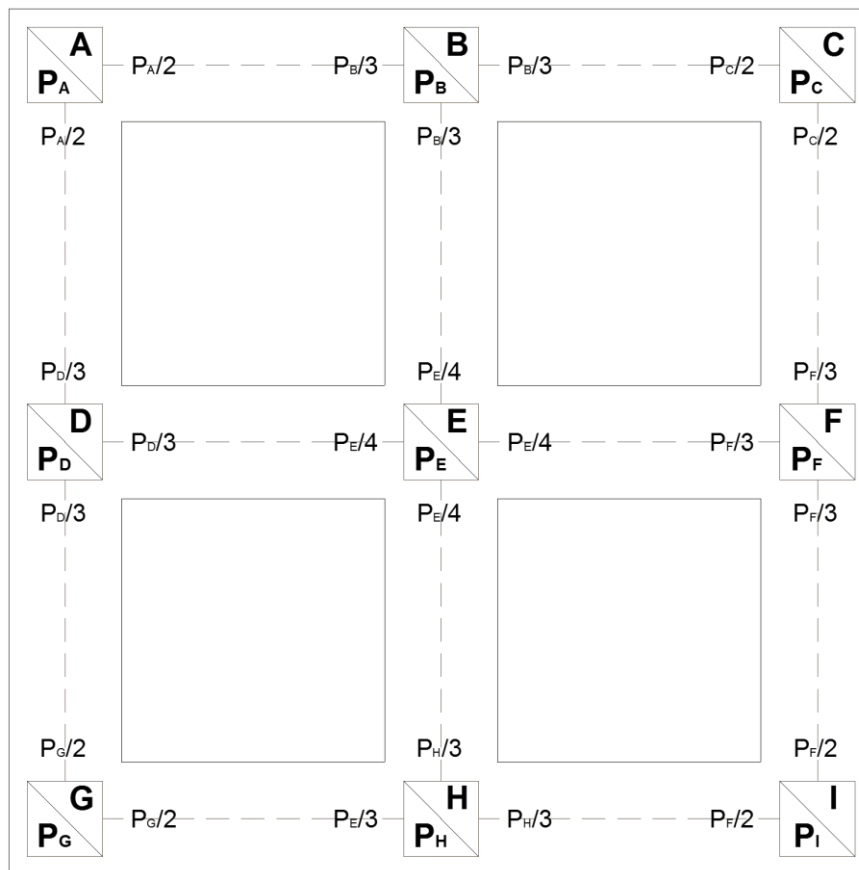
Transferencia de cargas de las pseudo columnas a la cimentaciones
